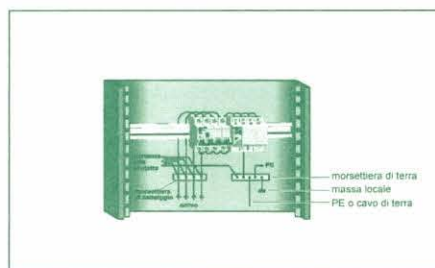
installazione dell'SPD in quadro alimentato dal basso e interruttore di protezione e SPD sulla stessa guida
